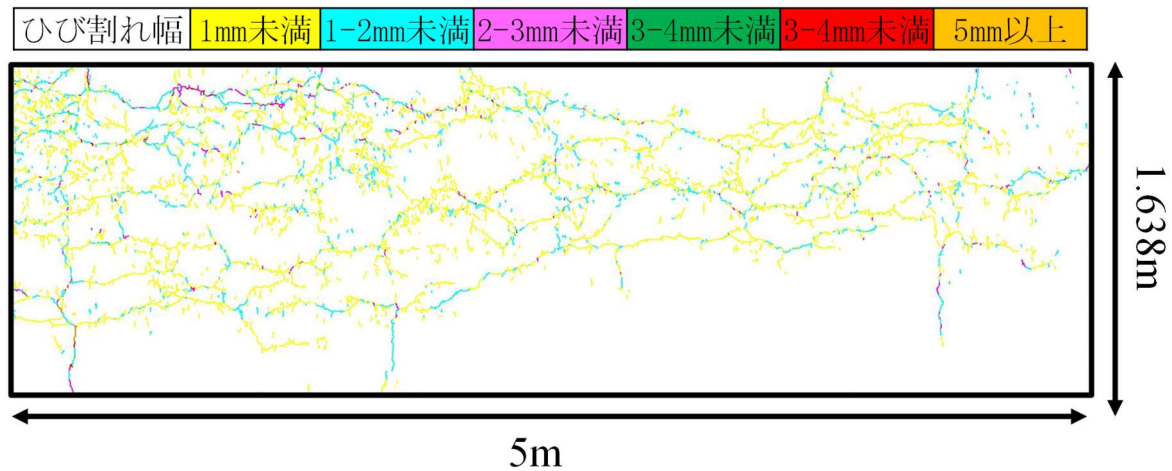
ひび割れ幅分類毎に階層化された展開図
